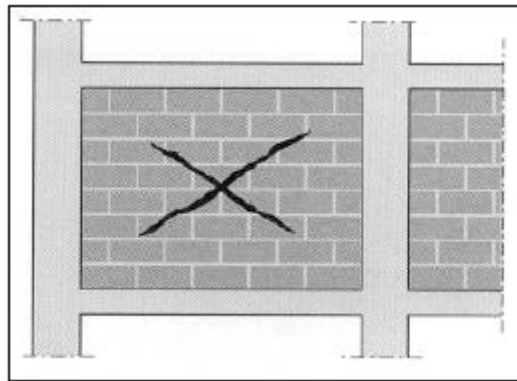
fissuration en X sur le portique (poteaux et poutres).
